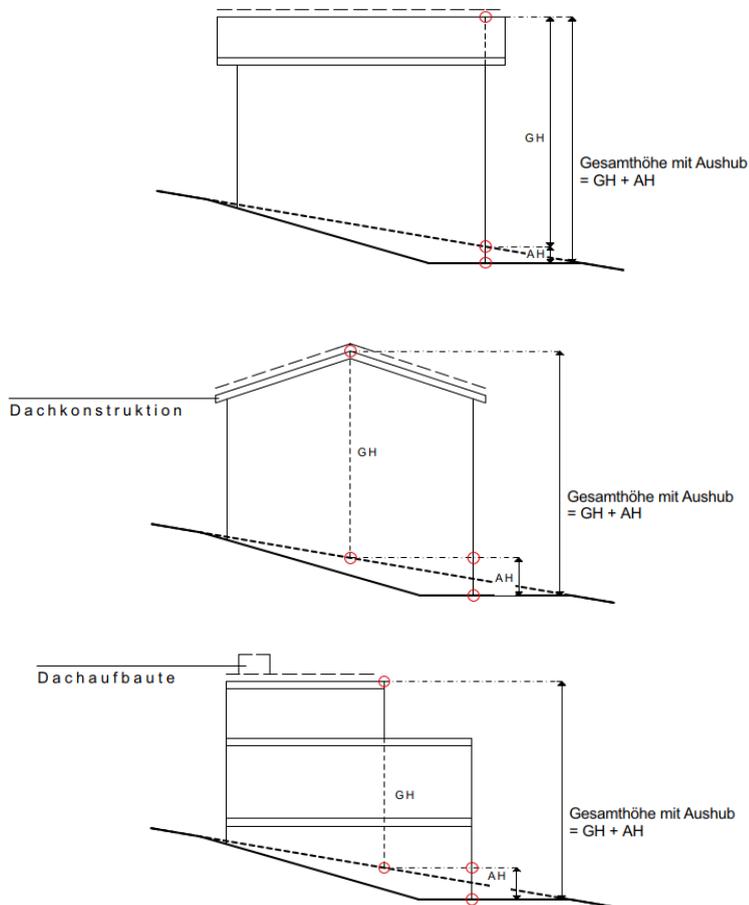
Aushubhöhe Art 11-12 BauG und Art. 9 BauV, Skizzen Kanton Wallis
